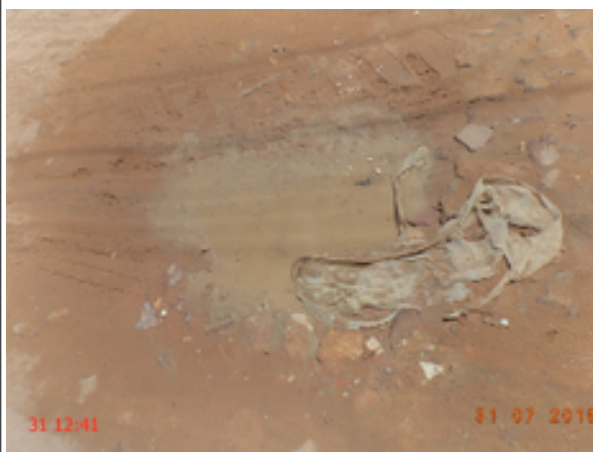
RDA: Registro de Manobra com vazamento na Rua Santo Antônio.
